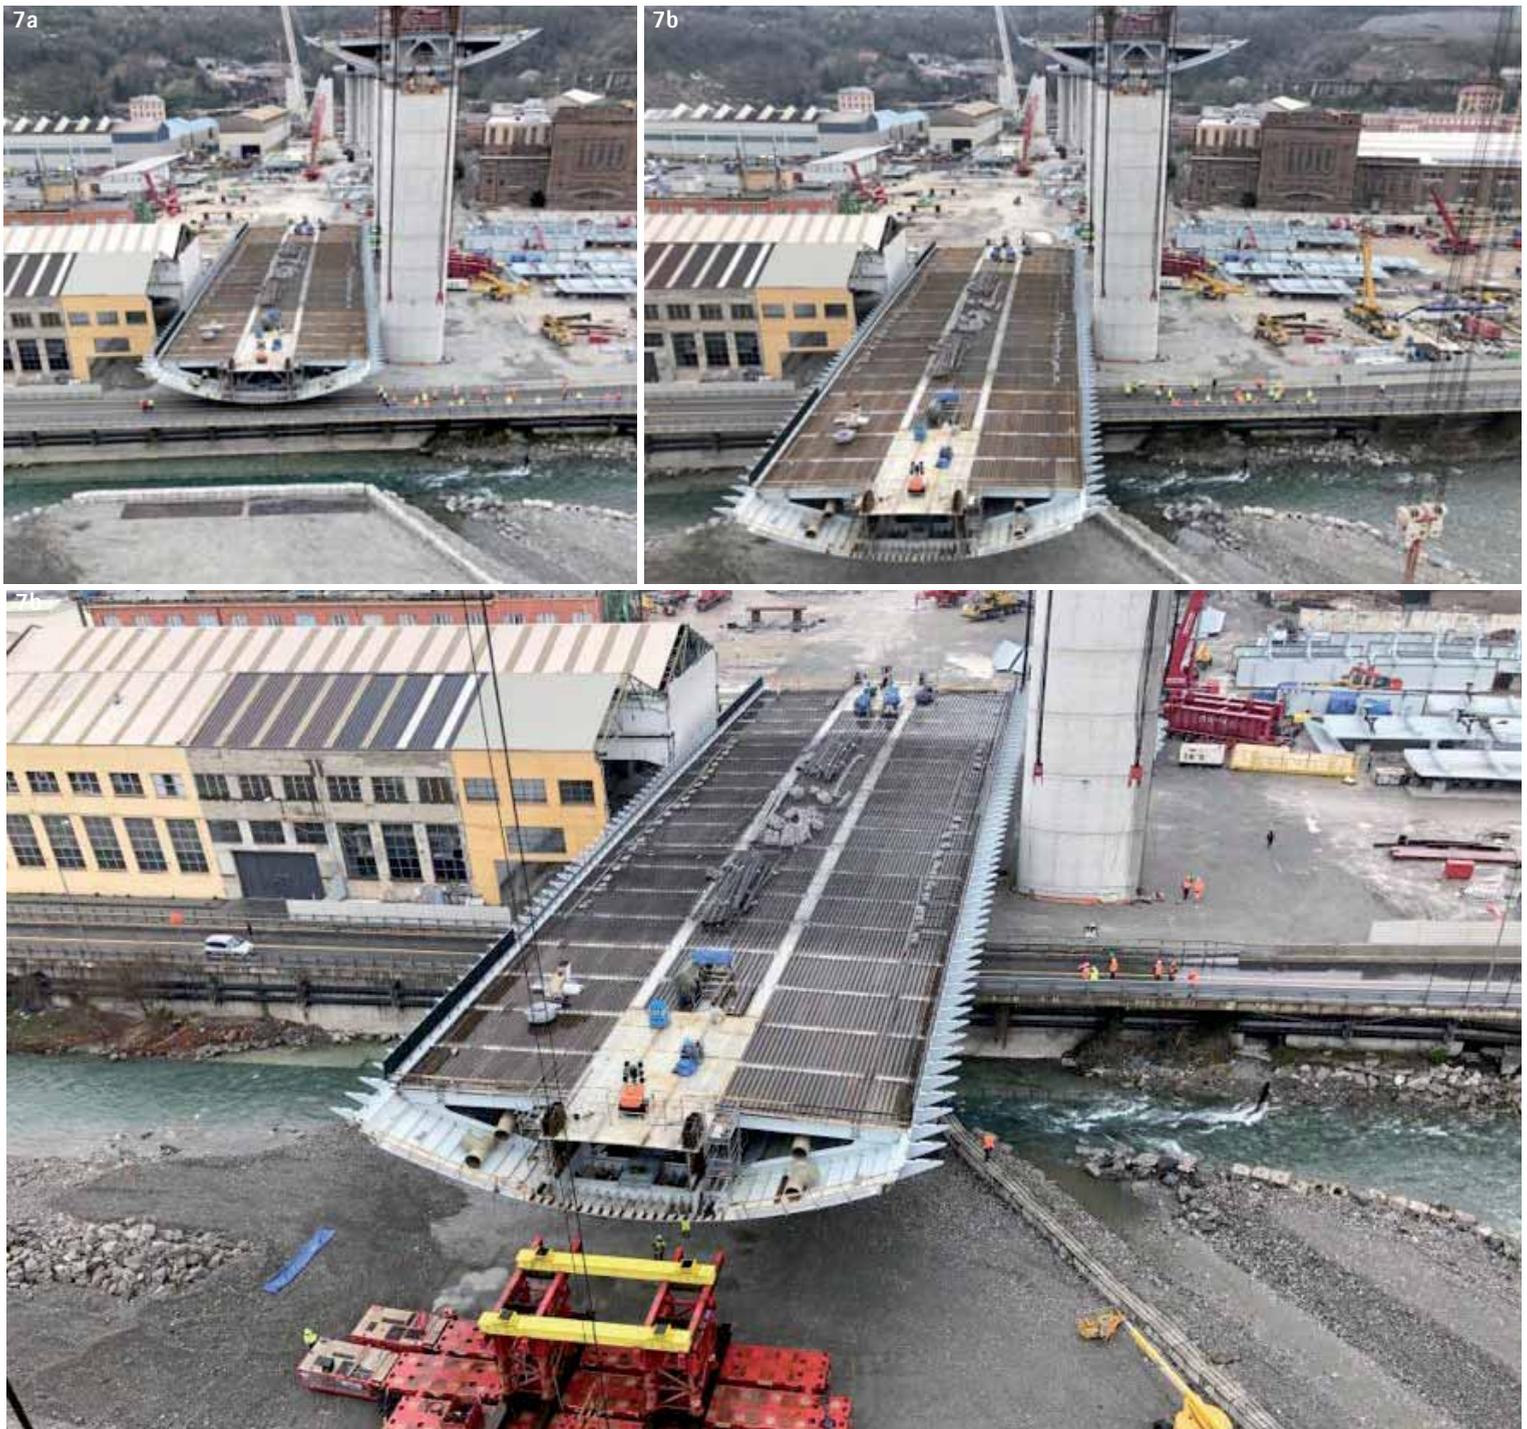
Movimentazione dell’impalcato di 100 m sul Polcevera
